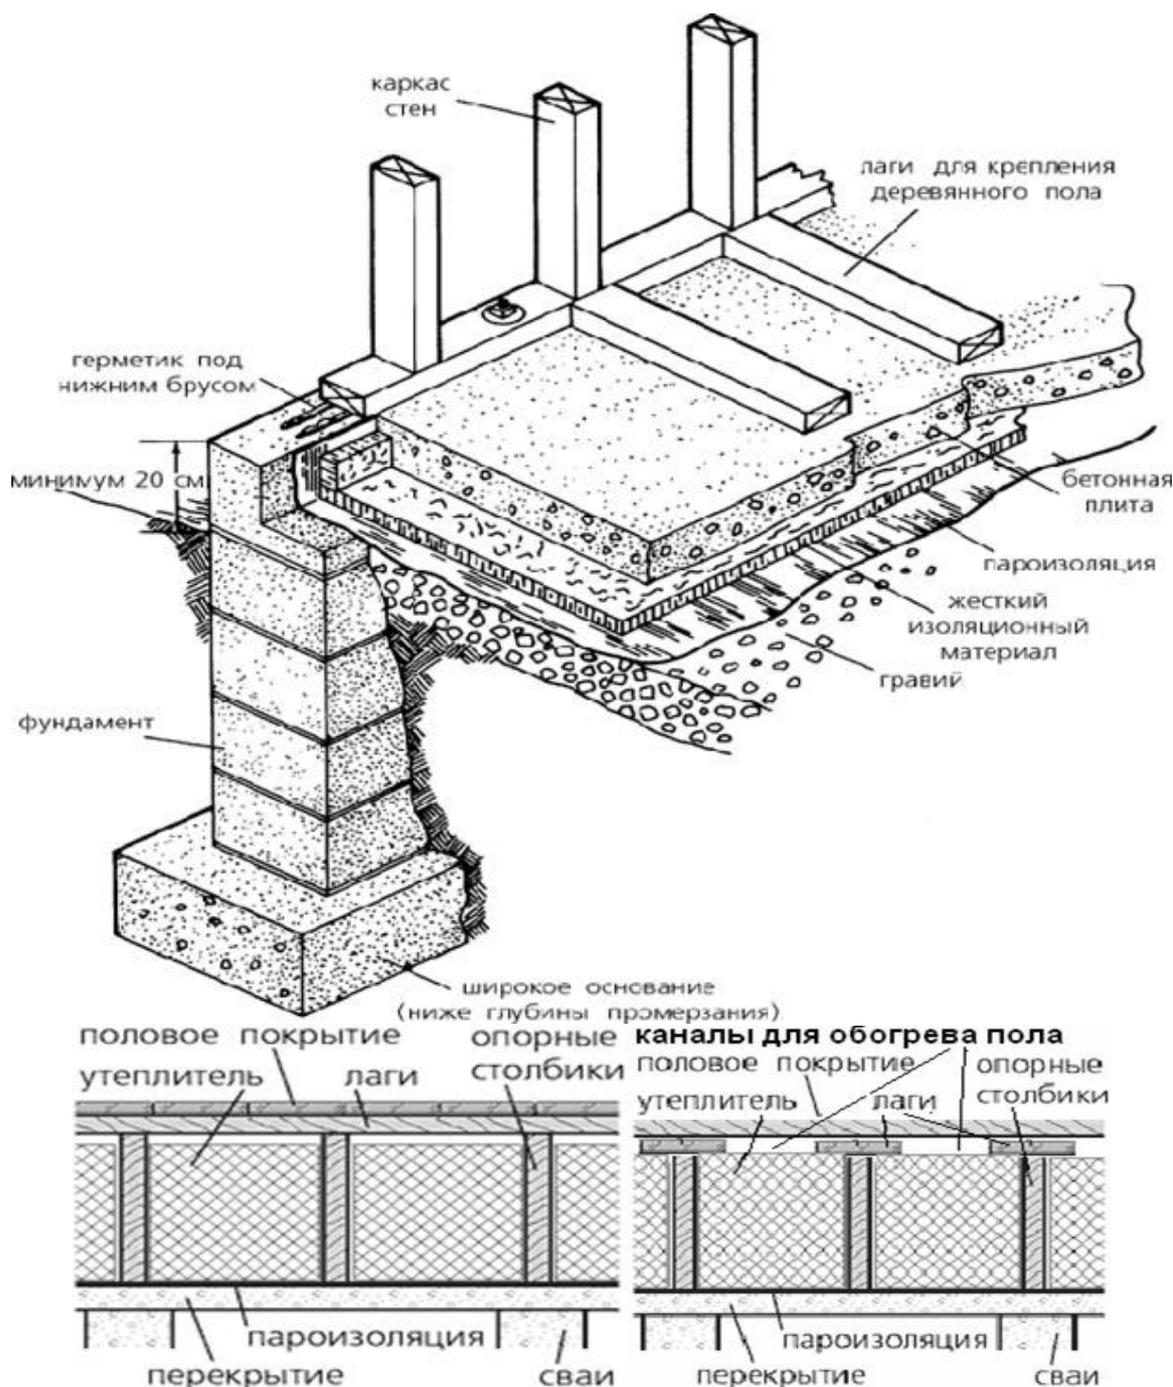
Перекрытие первого этажа: а) по грунту б) над вентилируемым подпольем.
